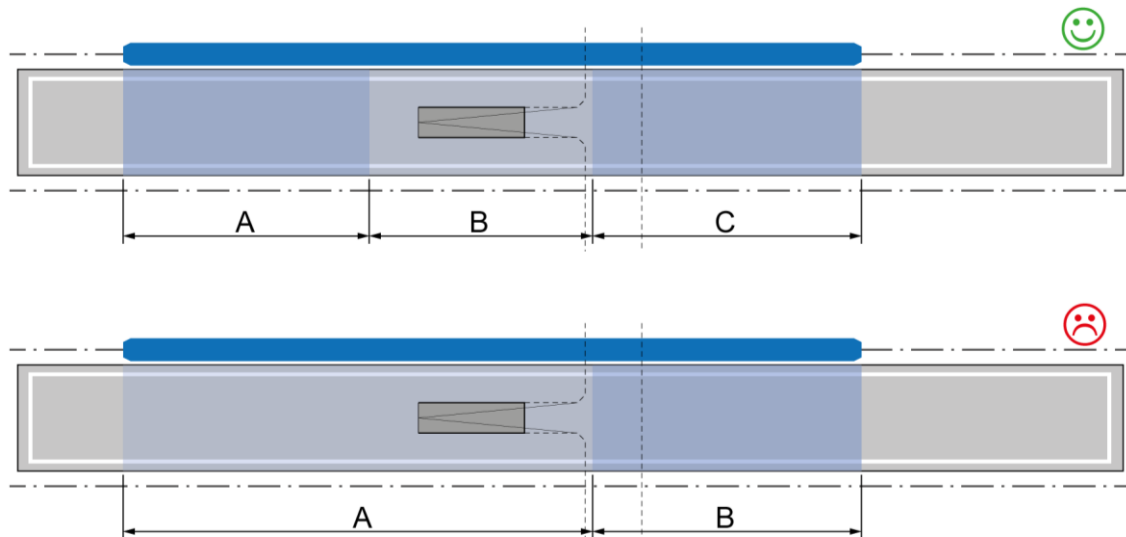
Bon/mauvais exemple de sectionnement des éléments
